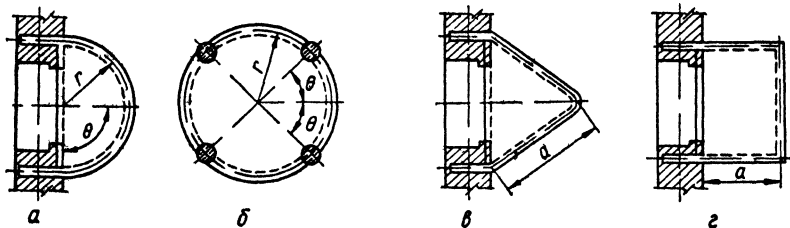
Балки криволинейные или ломаные, жестко соединенные в узлах:
